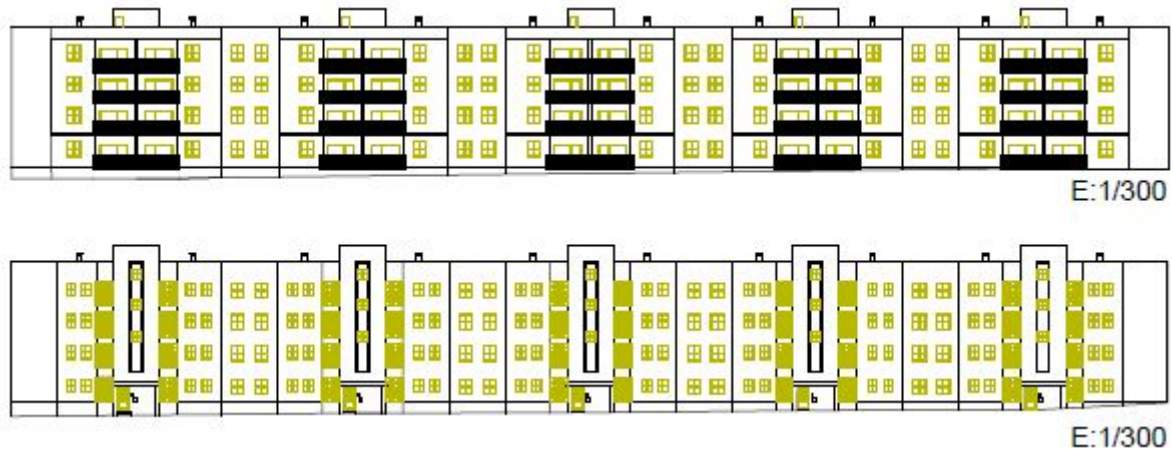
Alzado bloques de viviendas (Fuente:Anejo A)
